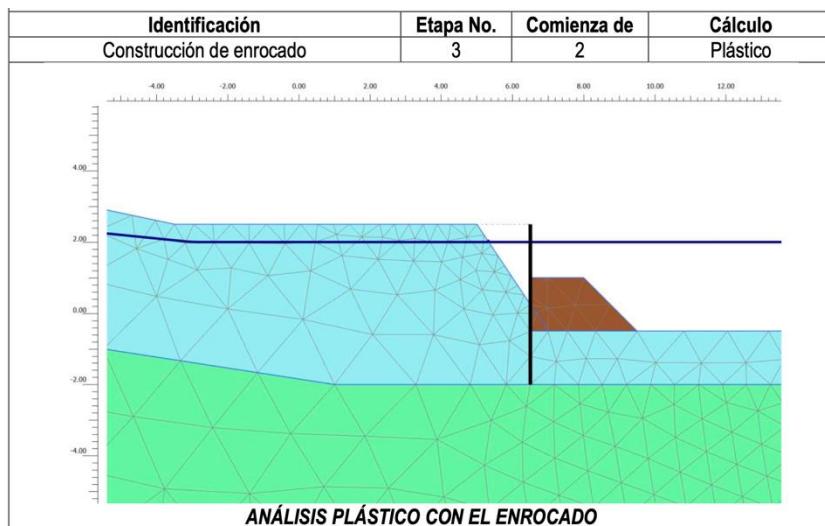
Construcción de enrocado sobre geotextil - Etapa 3
